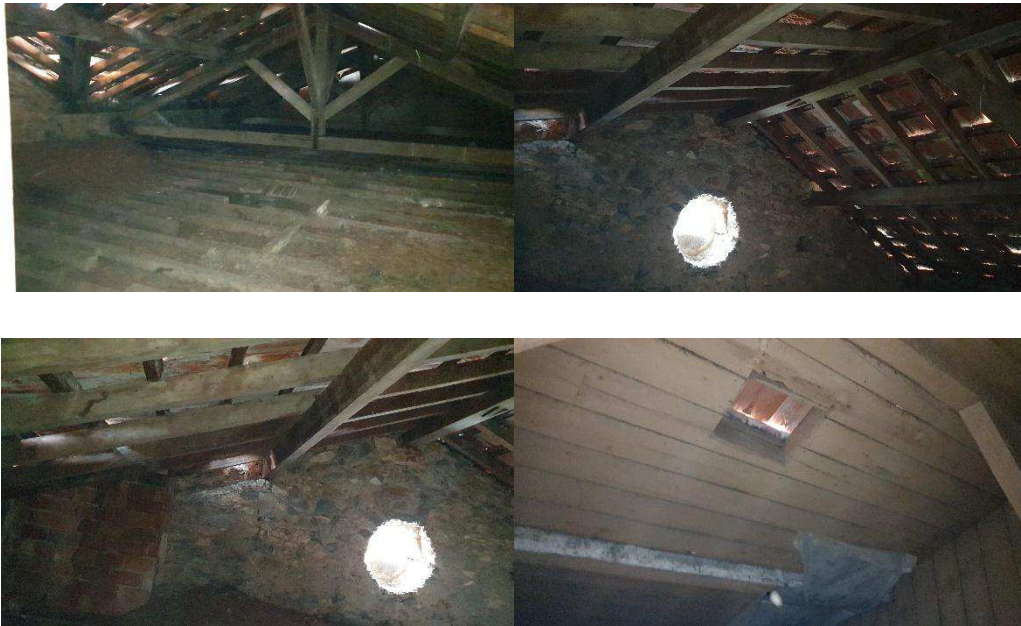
Moldura de madeira treliças telhado do projeto Dois-Portos
